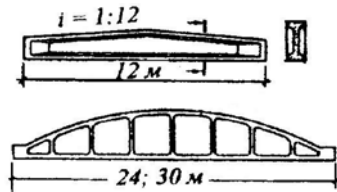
Збірні залізобетонні балки (а) і ферми (б) покриття для громадських будівель і споруд
